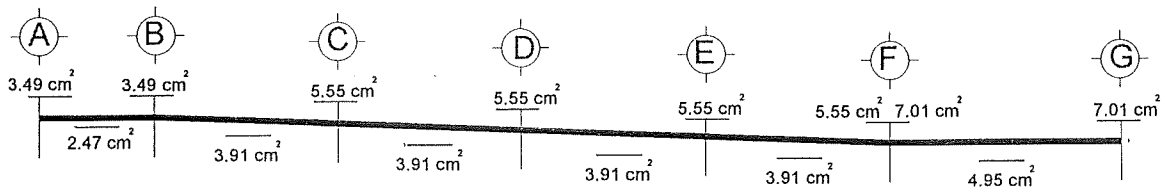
Áreas de acero de las traves de liga en la dirección X.
